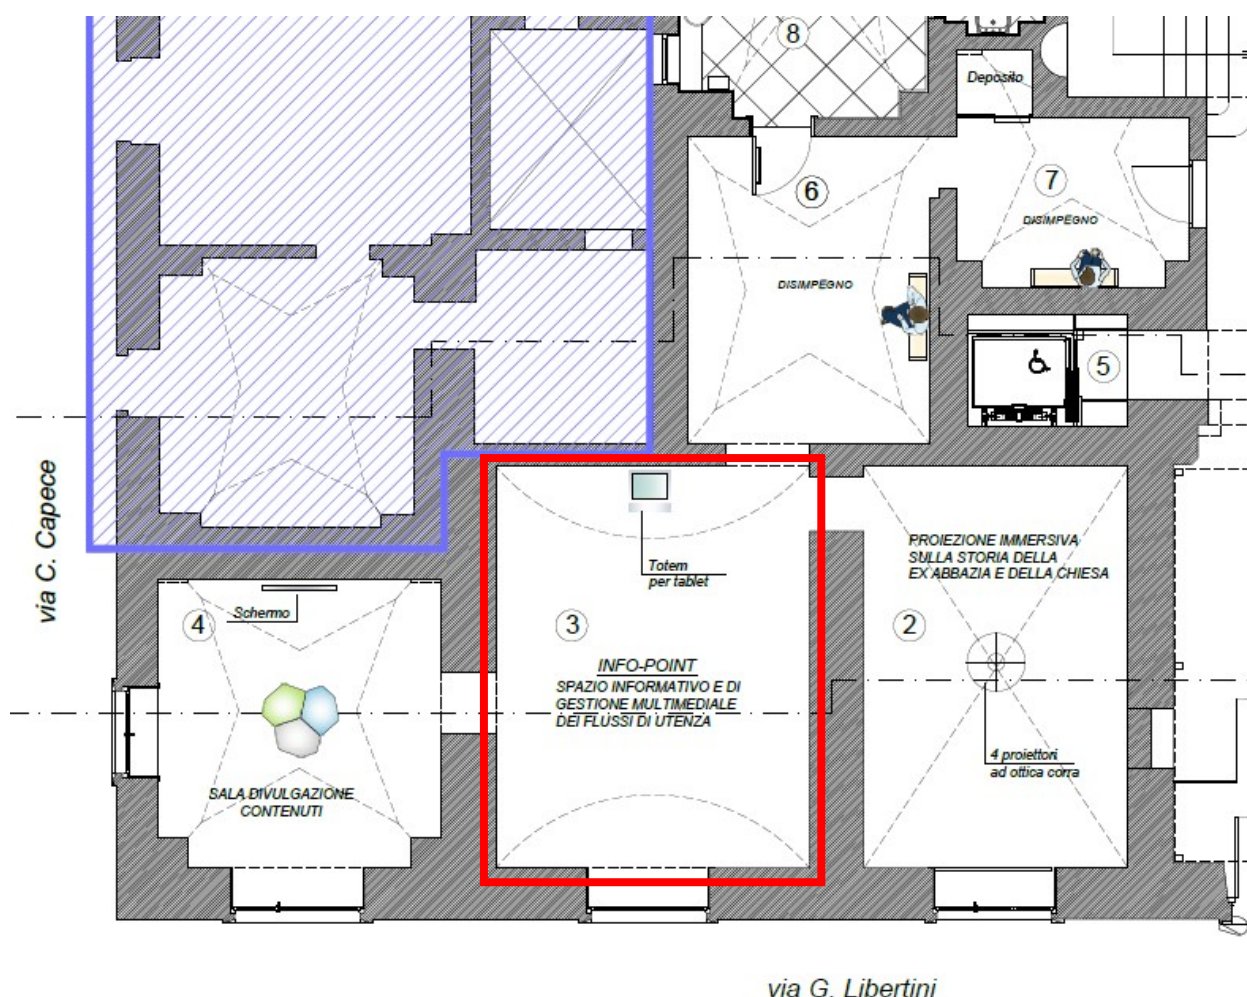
Stralcio della planimetria del piano terra con individuazione dello spazio informativo (rosso)
